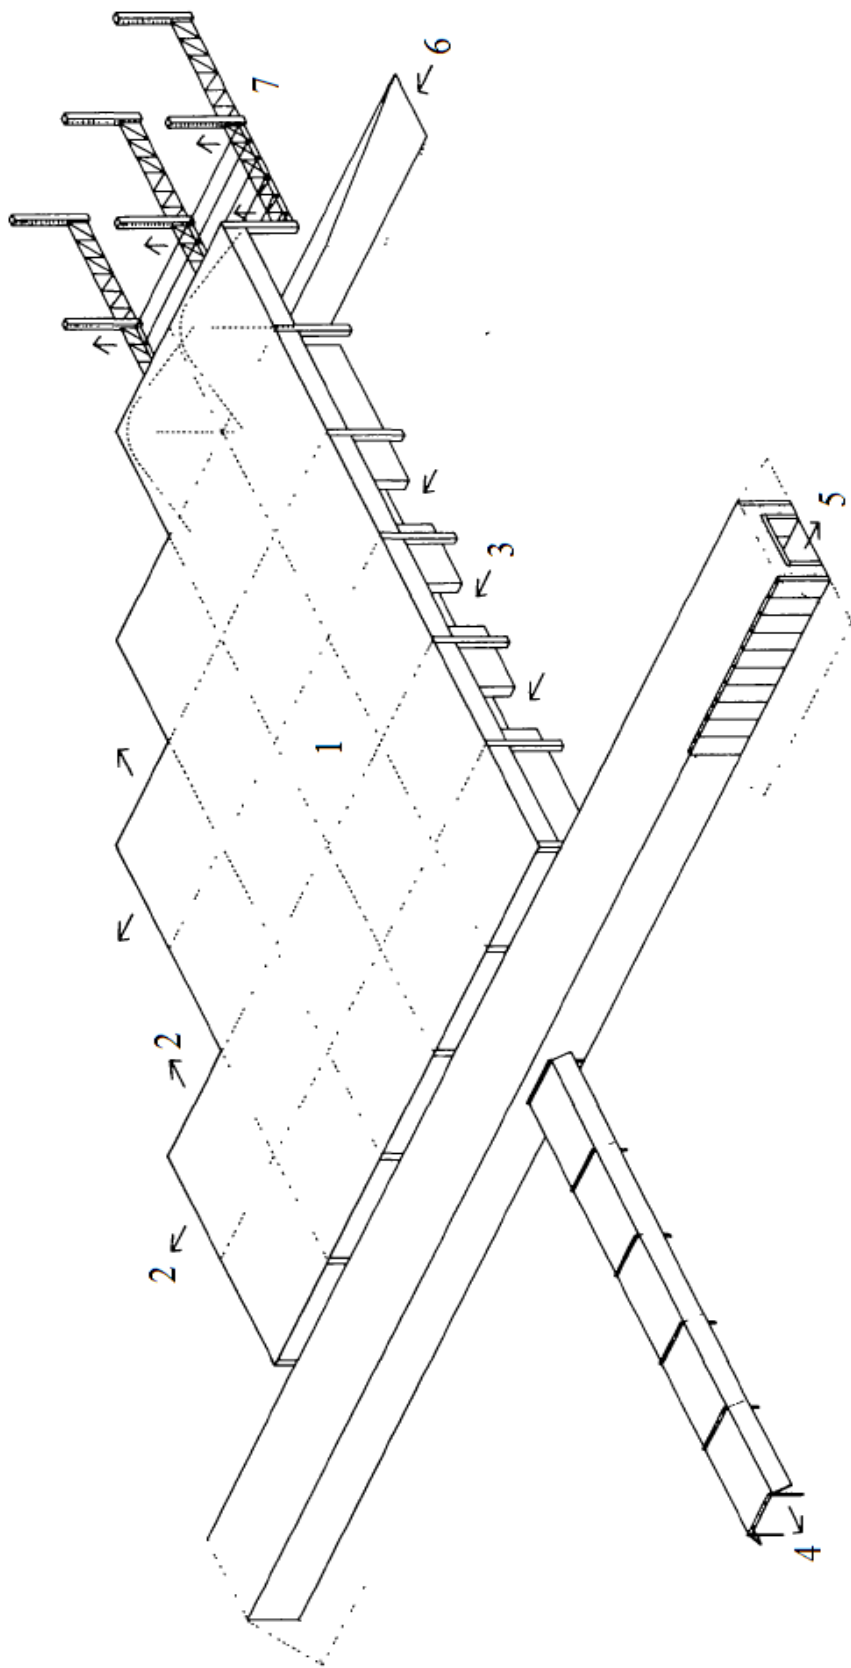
Загальний вид місячної бази. Плоский захисний екран з окремих секцій, під якими розташовуються герметичні корпуси.
